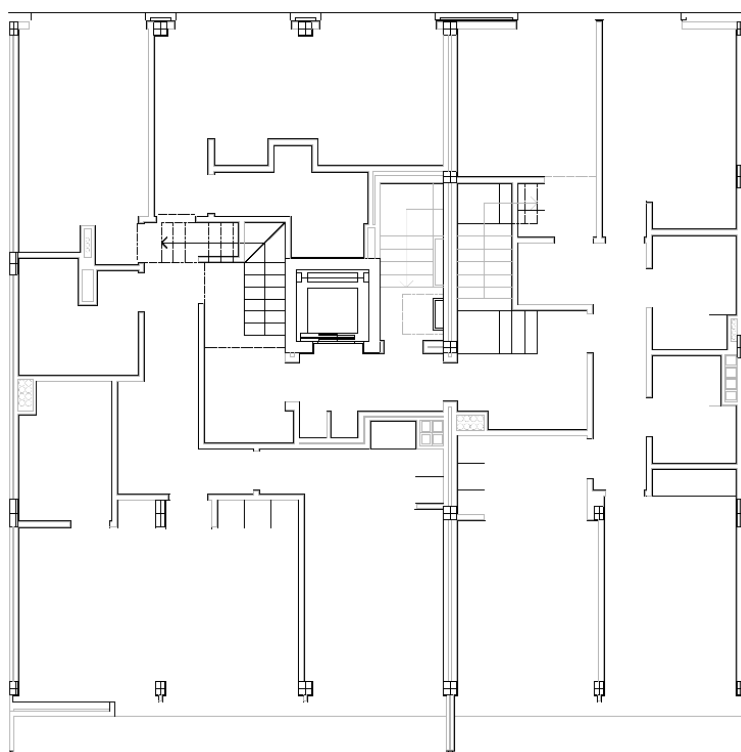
Planta de arquitectura dos Pisos 4 e 5.
